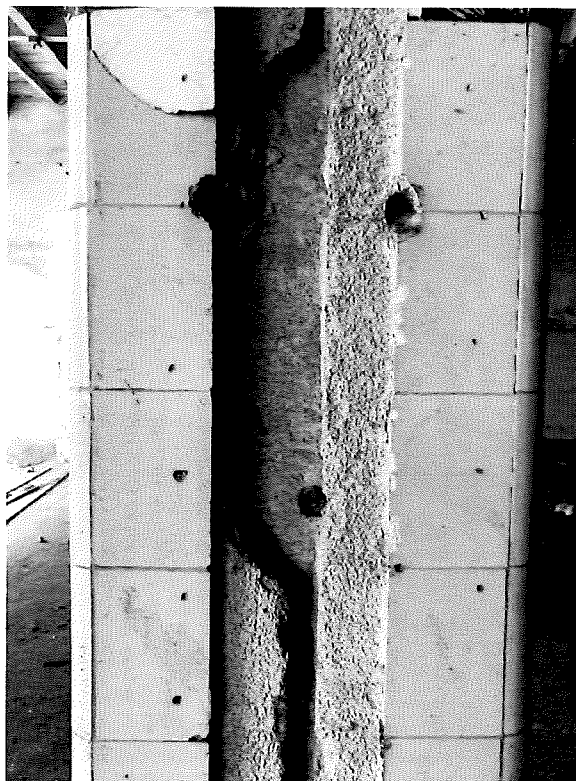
| Pormenor – Pilar em Pedra / Revestimento
